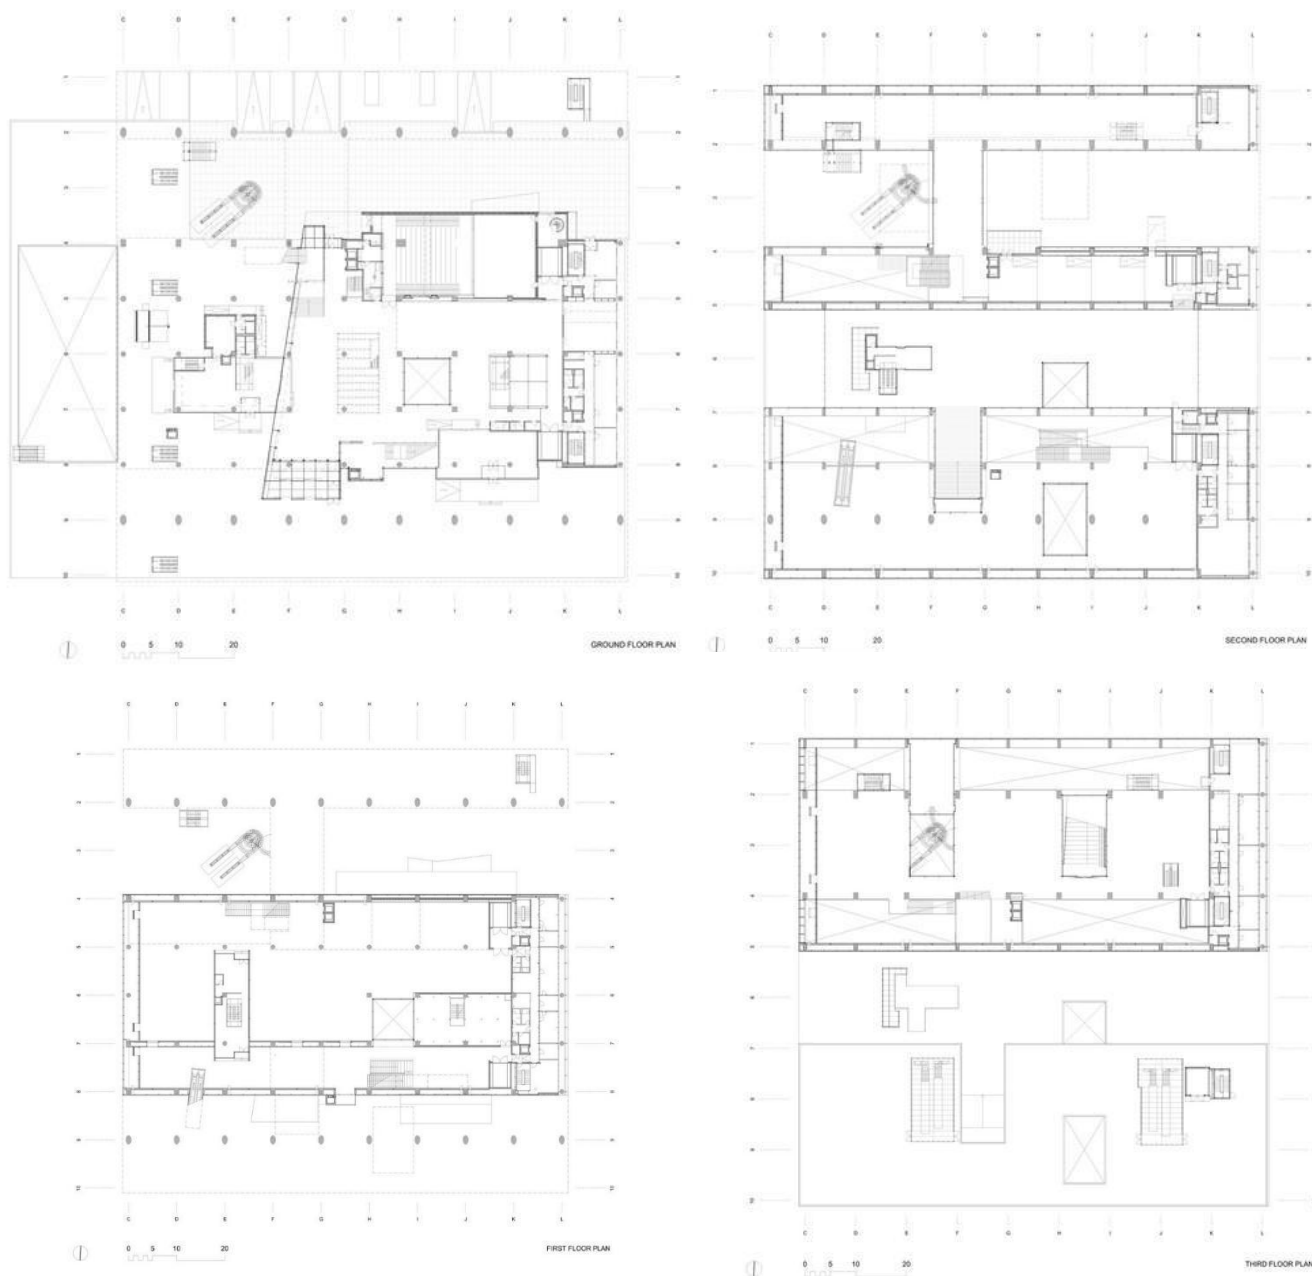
Креслення планів поверхів будівлі [62]
